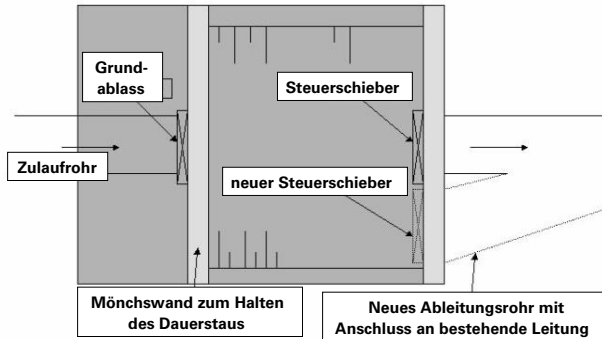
Grundriss eines Mönchbauwerks, links Schiebergestänge, rechts zwei Betriebsauslässe.
